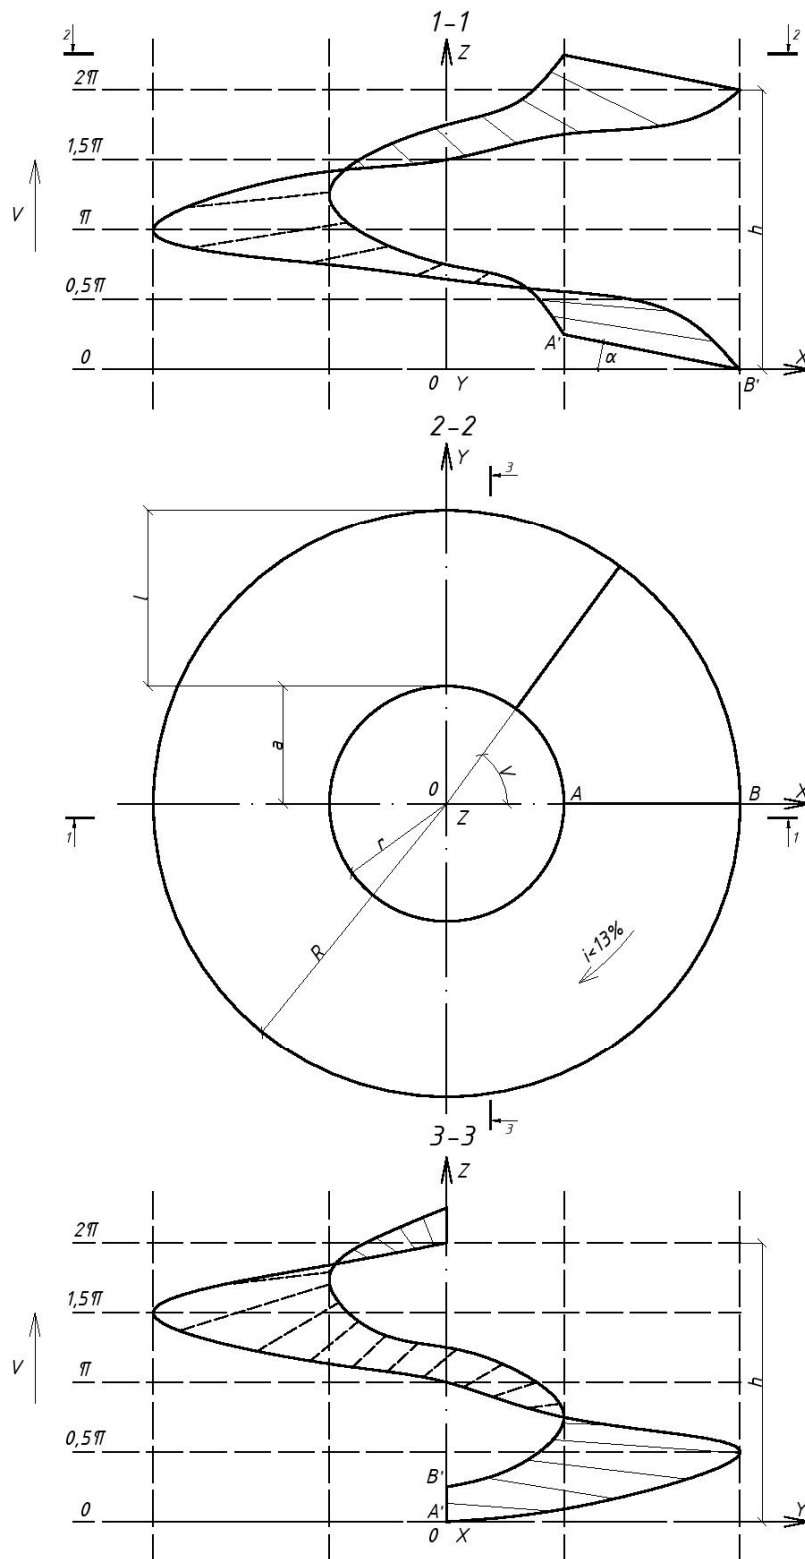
Схема утворення кругового пандуса як перекриття рампи з ухилом назовні:
